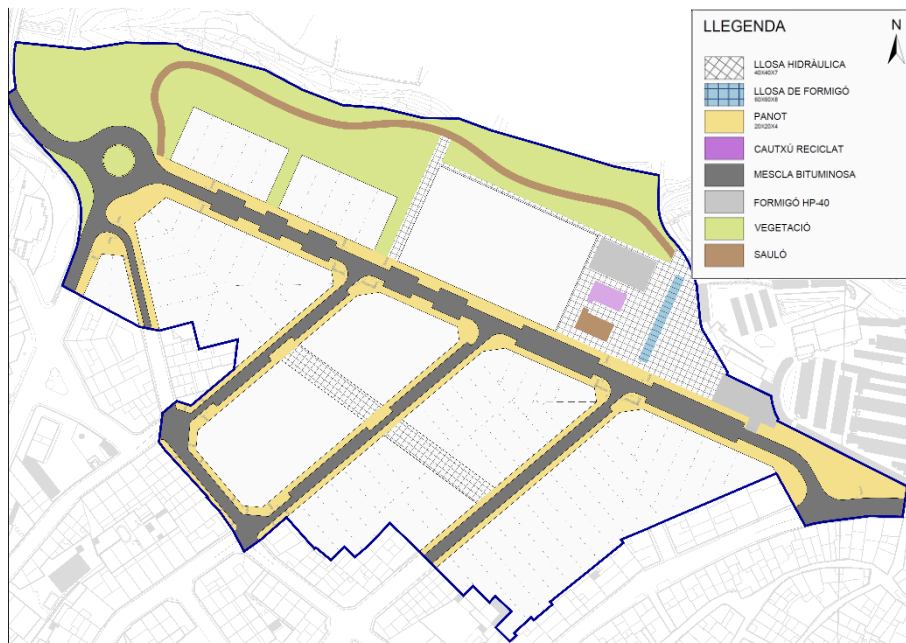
Planta del sector Hort de Caparó amb els fermes i paviments seleccionats.
